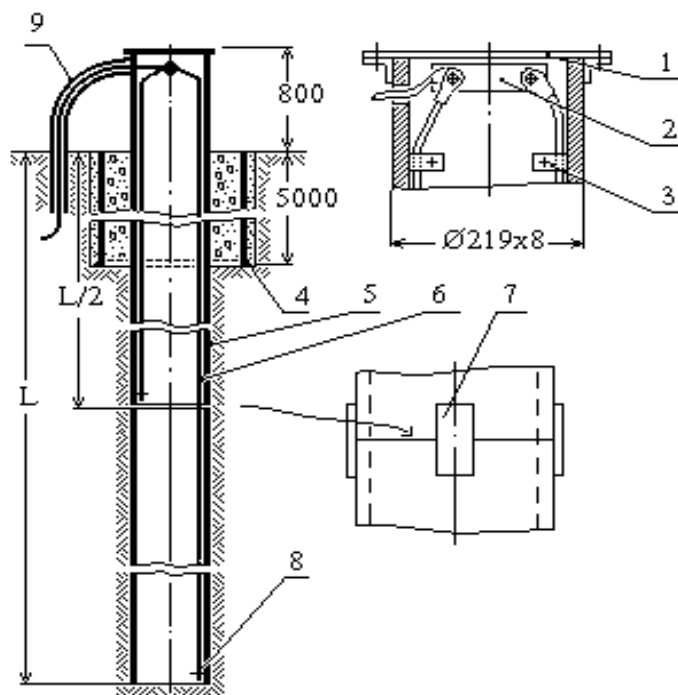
Глубинный анодный заземлитель из стальной трубы. 1-крышка; 2-клеммник; 3-хомут; 4-направляющая труба; 5-стальная труба; 6- кабель; 7-накладки приварные; 8-контактный узел; 9- кабель питания.
